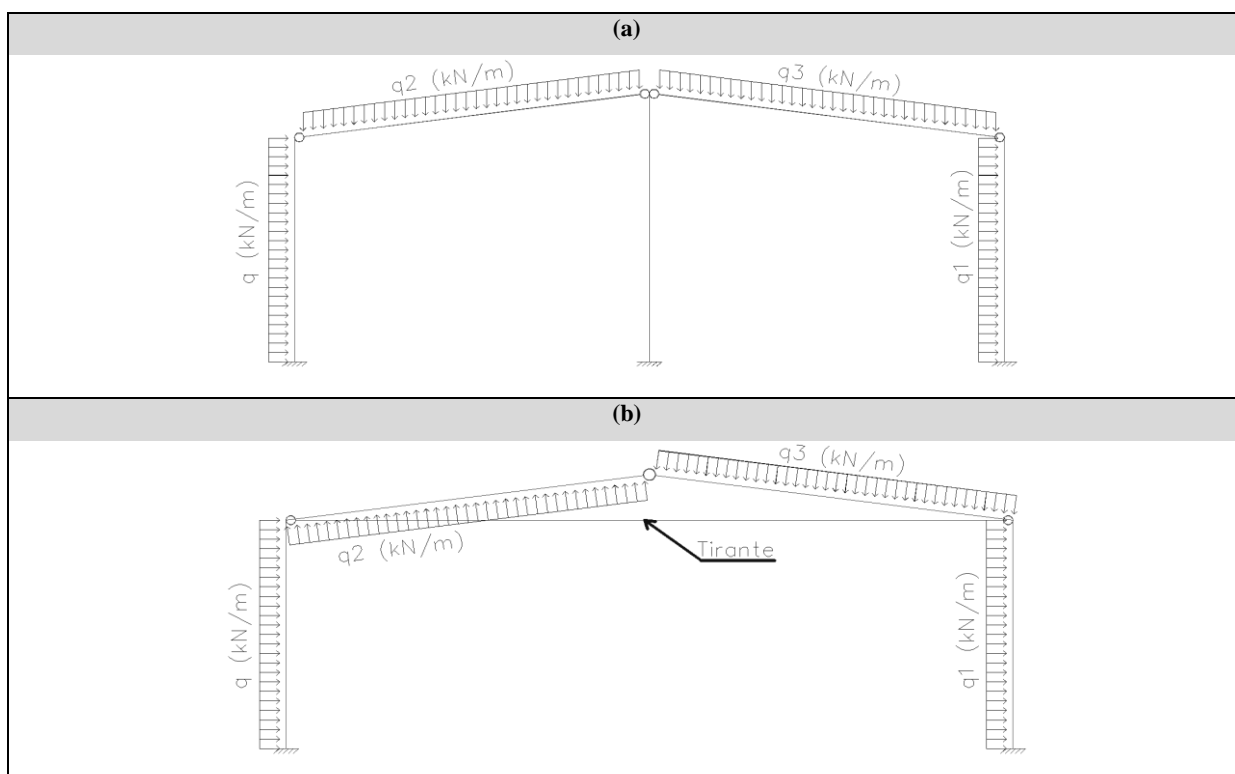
2 – Esquemas estruturais: (a) Pórtico com viga inclinada (viga “I”); (b) viga inclinada (pórtico atirantado).
